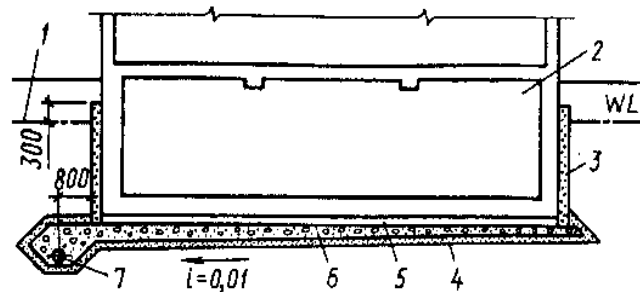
Пластовий дренаж: 1 – рівень підземних вод; 2 – заглиблене приміщення, що захищається; 3 – пристінний дренаж; 4 – піщаний шар; 5 – захисне покриття щебеневого шару; 6 – піщано-гравійний або щебеневий шар; 7 – труба
